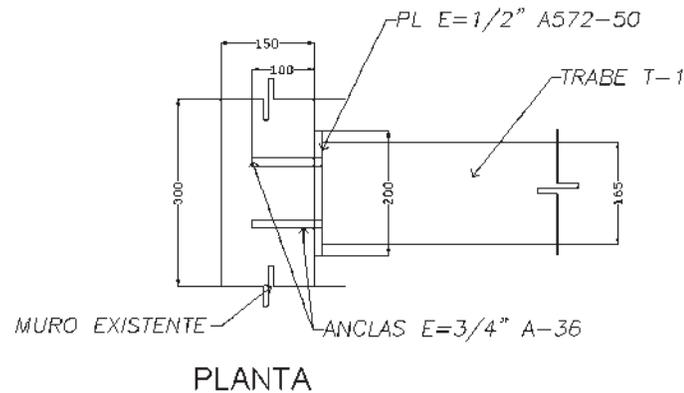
Vista en planta de la placa ahogada en castillo para fijar armaduras.
